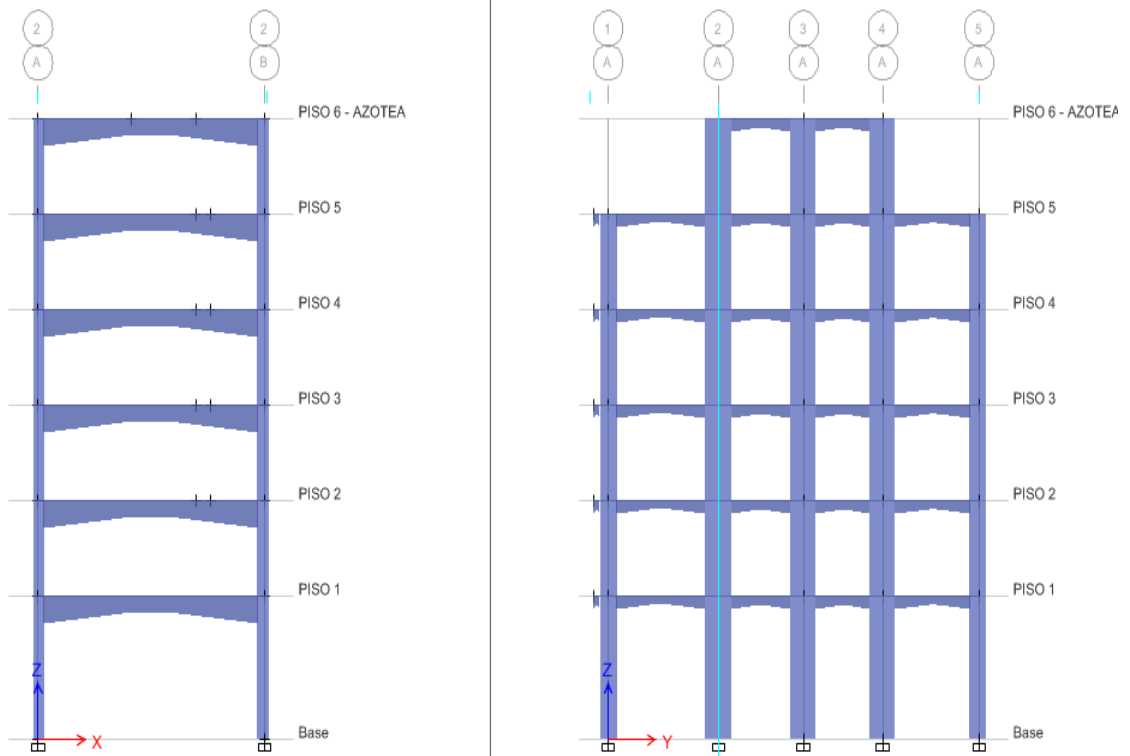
32 Vista de los elementos - CASO N°06.
